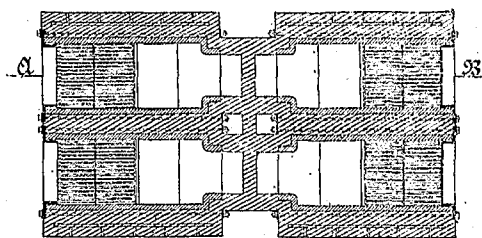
Grundriss i. d. Höhe C-D.
